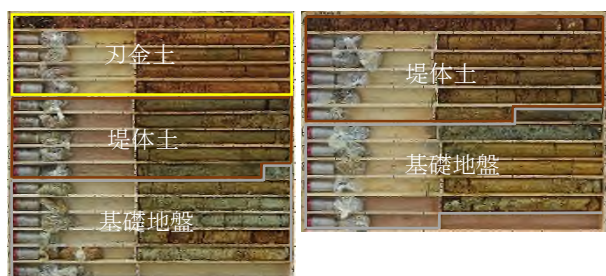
Bor-2 コア 写真-4 Bor-3 コア
